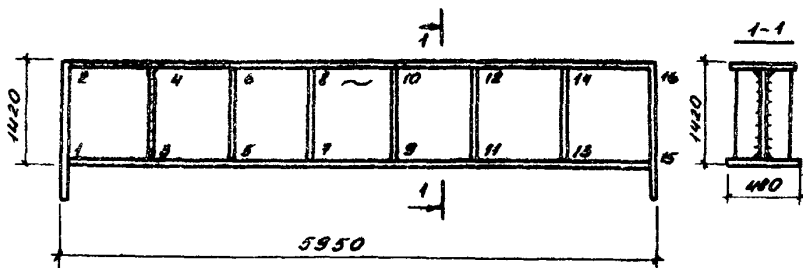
Подкрановая балка (БК) в осях 23-24 ряда В пролета ВГ
